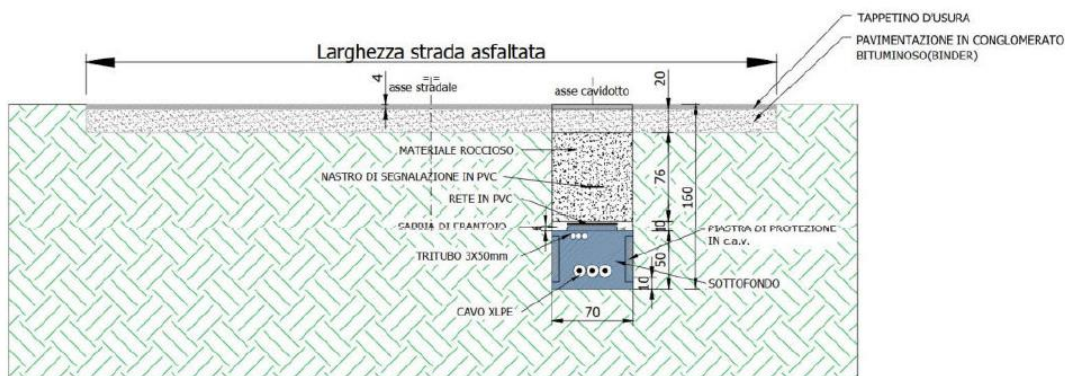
Sezioni tipiche posa cavi AT su strade asfaltate
